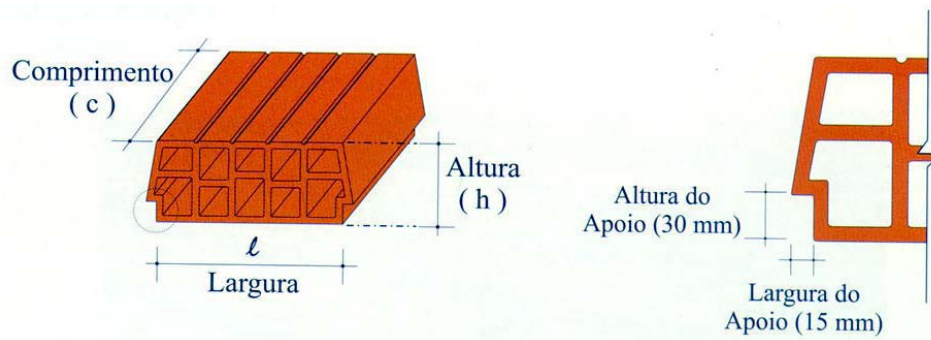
Blocos cerâmicos de enchimento (LAJES FAULIM, 1998).
